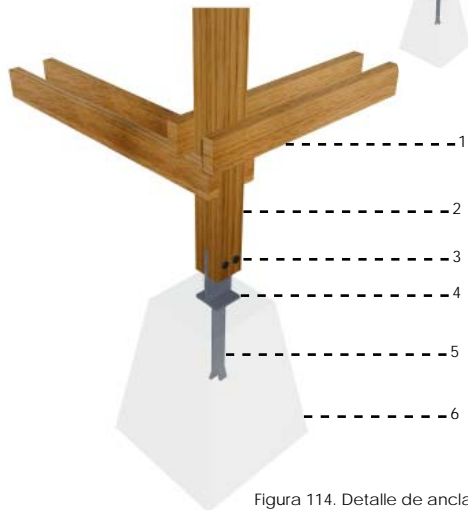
Detalle de anclaje del Sistema Pilar y Viga.
